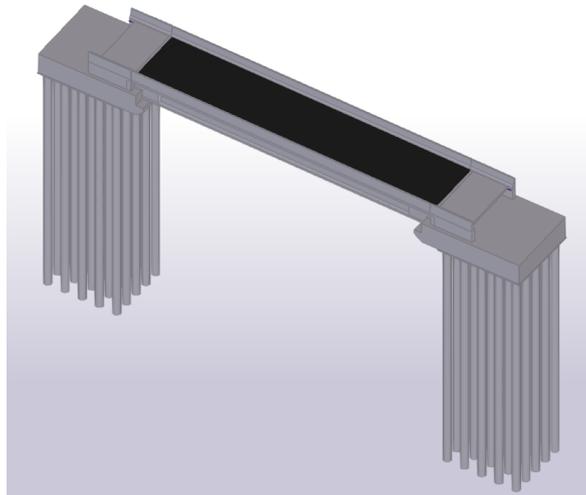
Penjadwalan proyek dengan Tekla Structures
